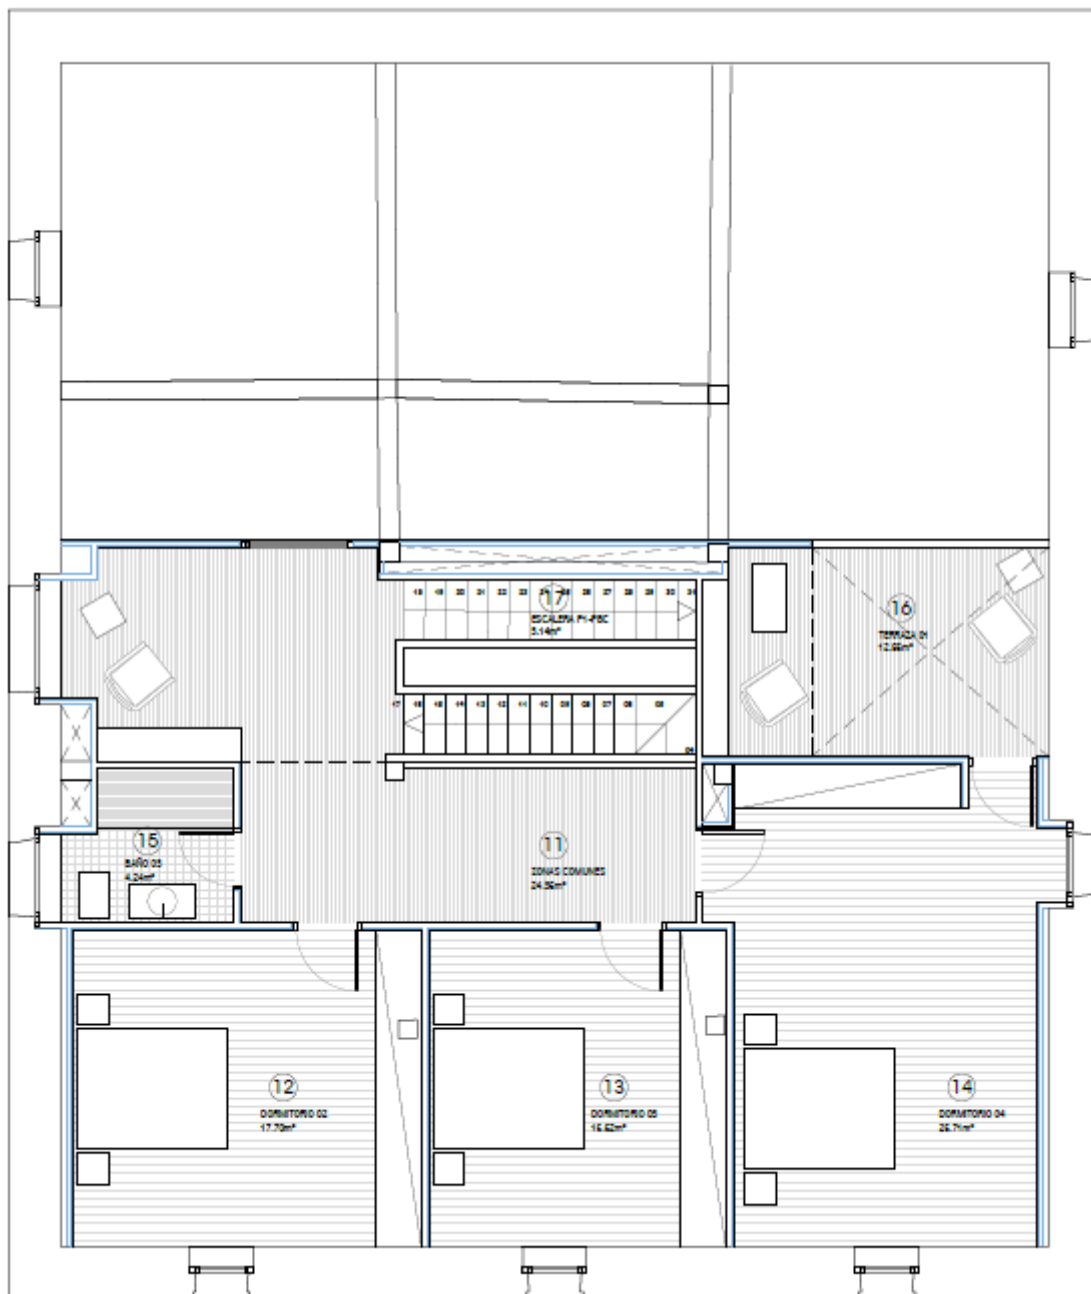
Distribución y superficie Planta Primera (Plano 04.2)
